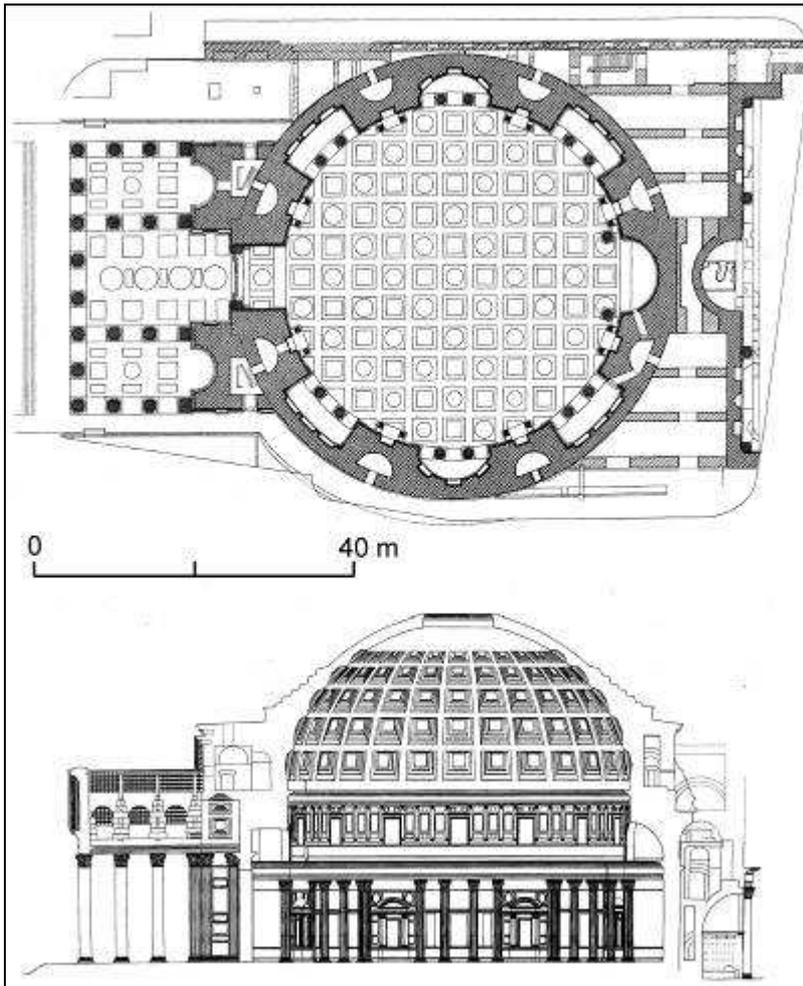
Roma. Pantheon. Pianta e sezione longitudinale (FINE LICHT 1968)
